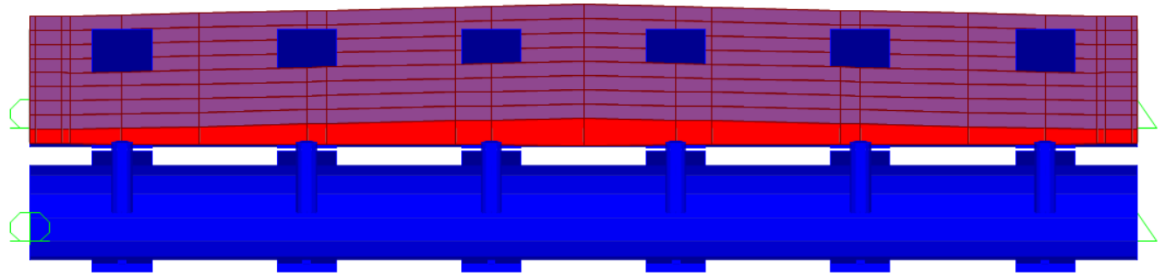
Vista da ligação no modelo estrutural das longarinas nas carlingas com barra de rigidez
